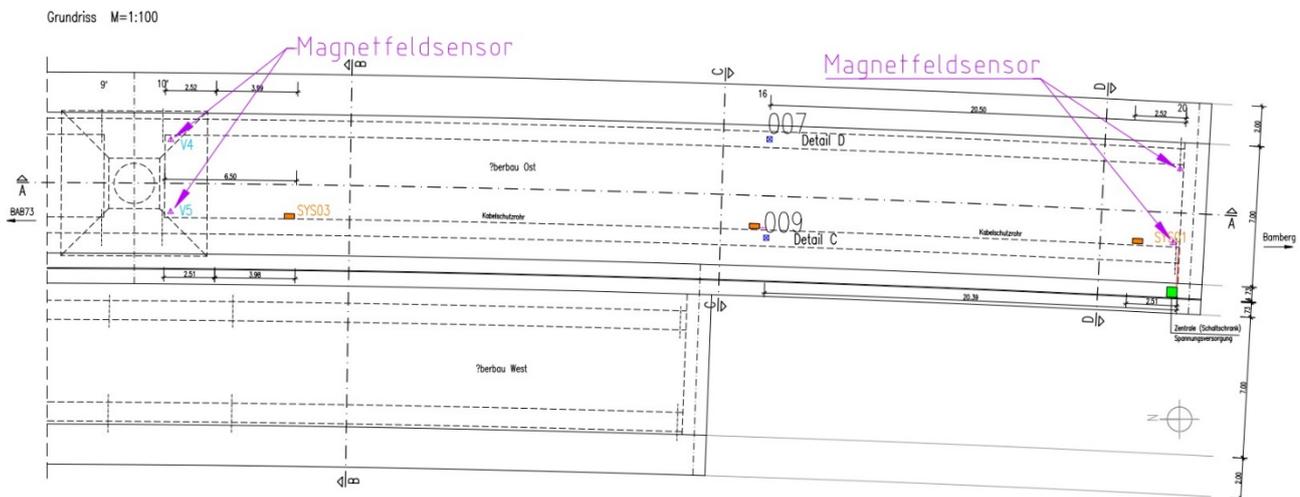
Lage der Magnetfeldsensoren in der Draufsicht; Quelle: Büro für Strukturmechanik GmbH
